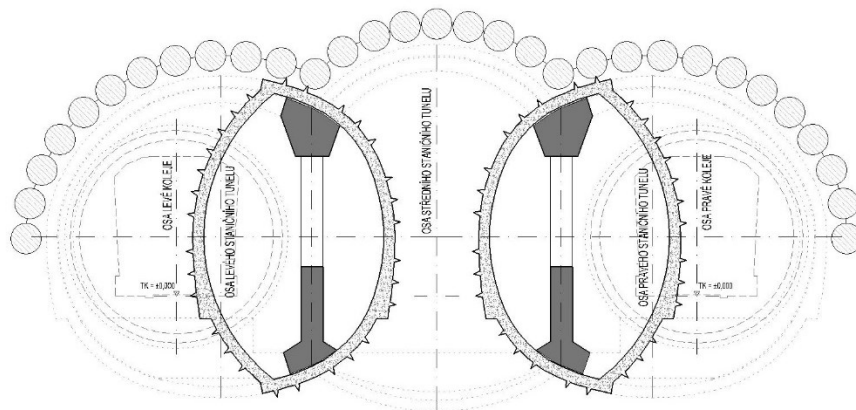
Varianta 0 - 1. Fáze výstavby
